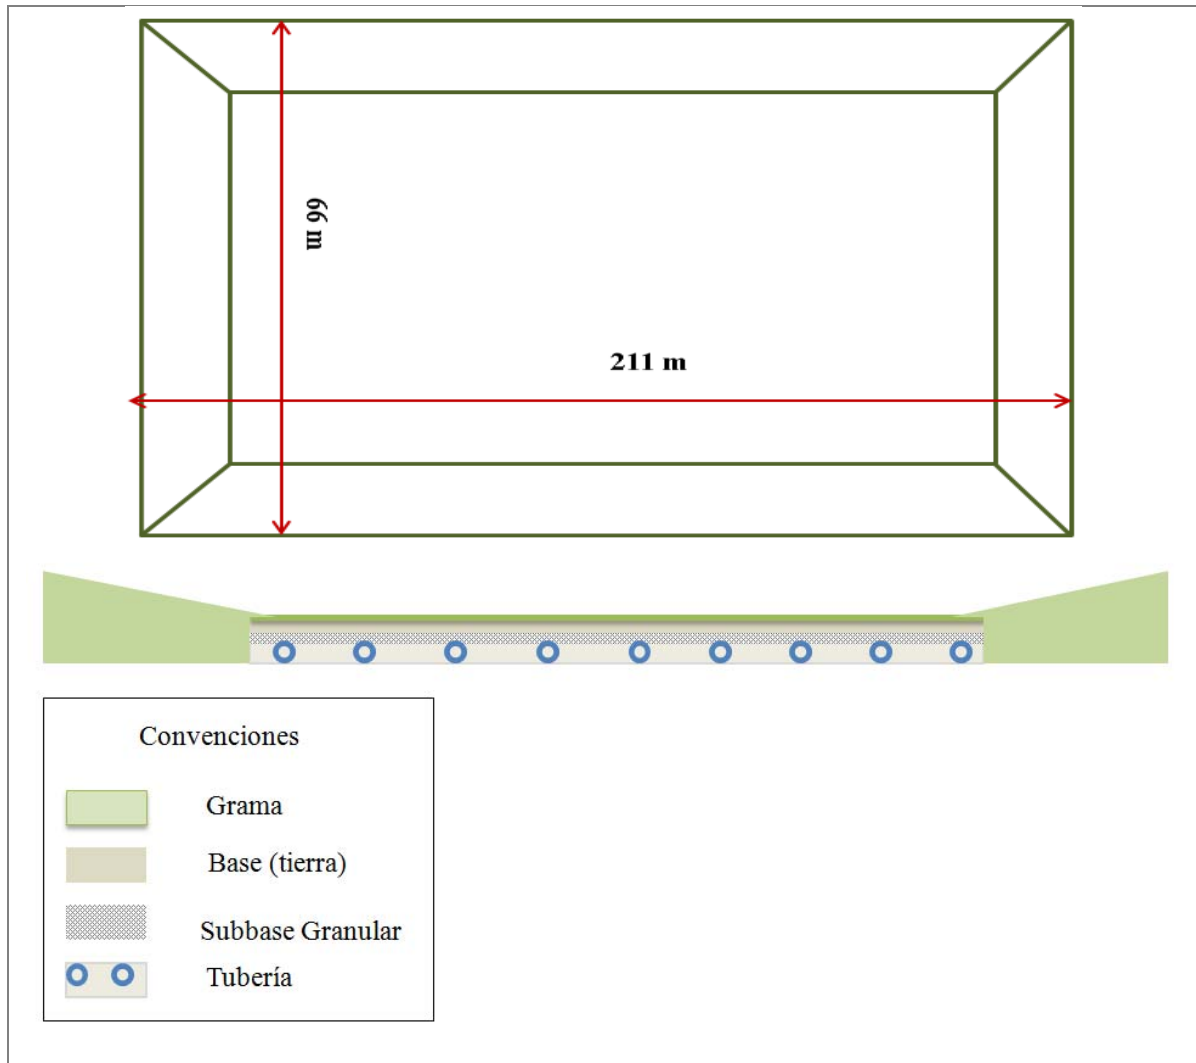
Vista en planta y perfil depósito de detención superficial
